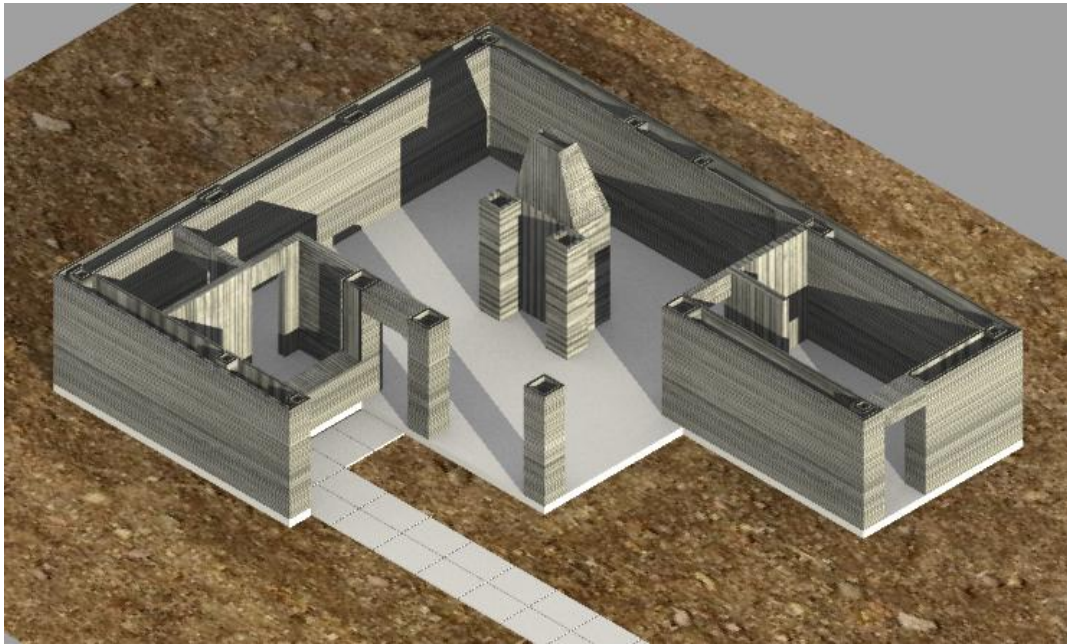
Vista axonométrica de los muros de construcción aditiva.
